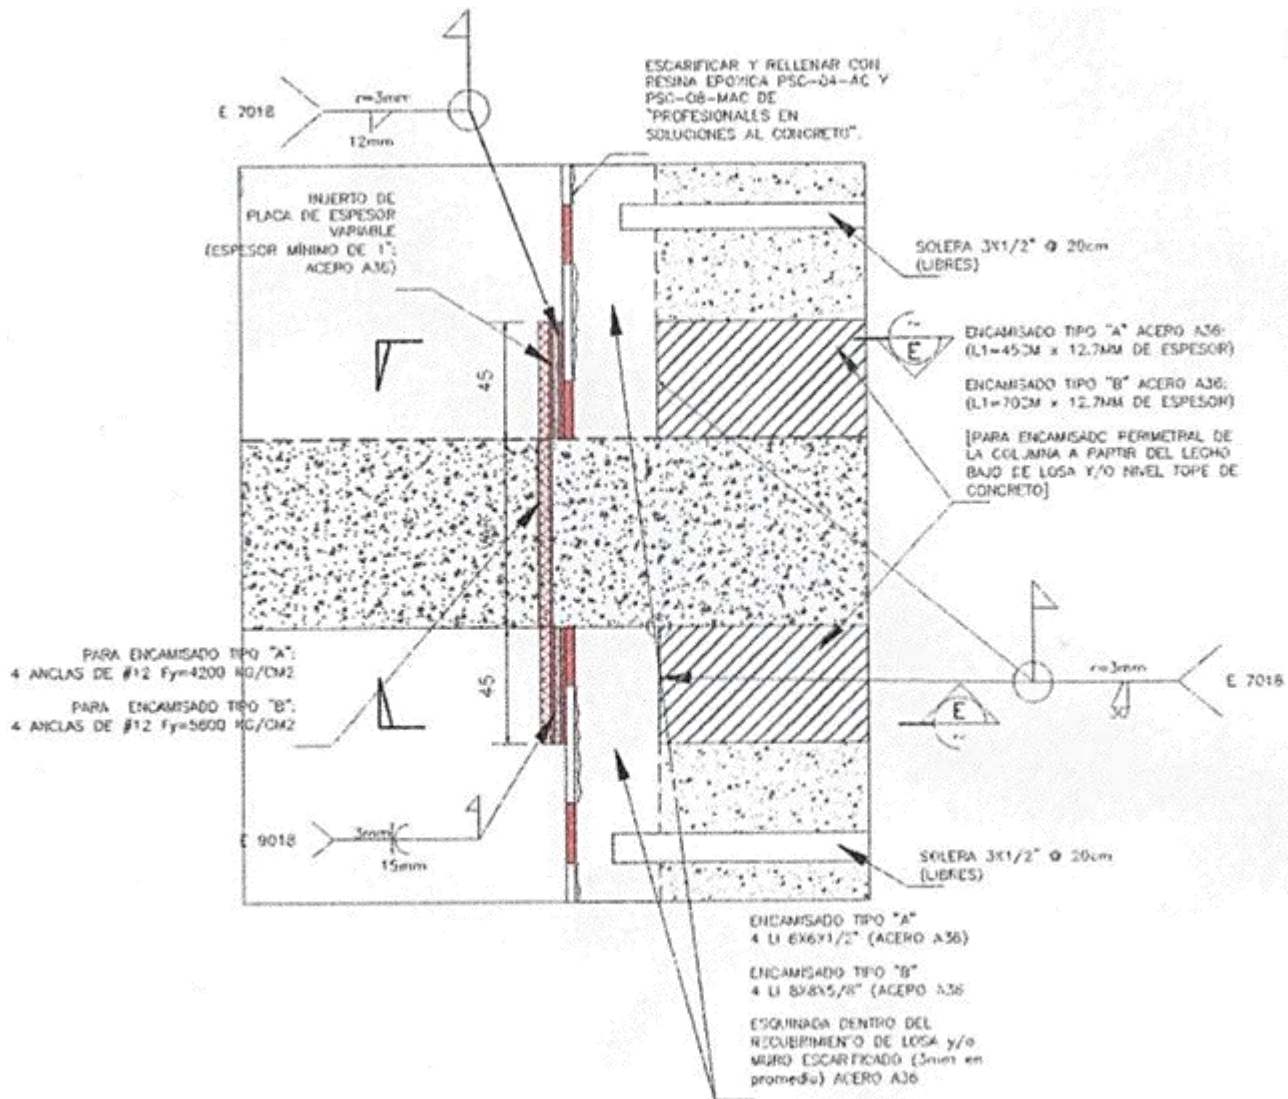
Uniones de ángulos, placas y anclas con soldaduras.
